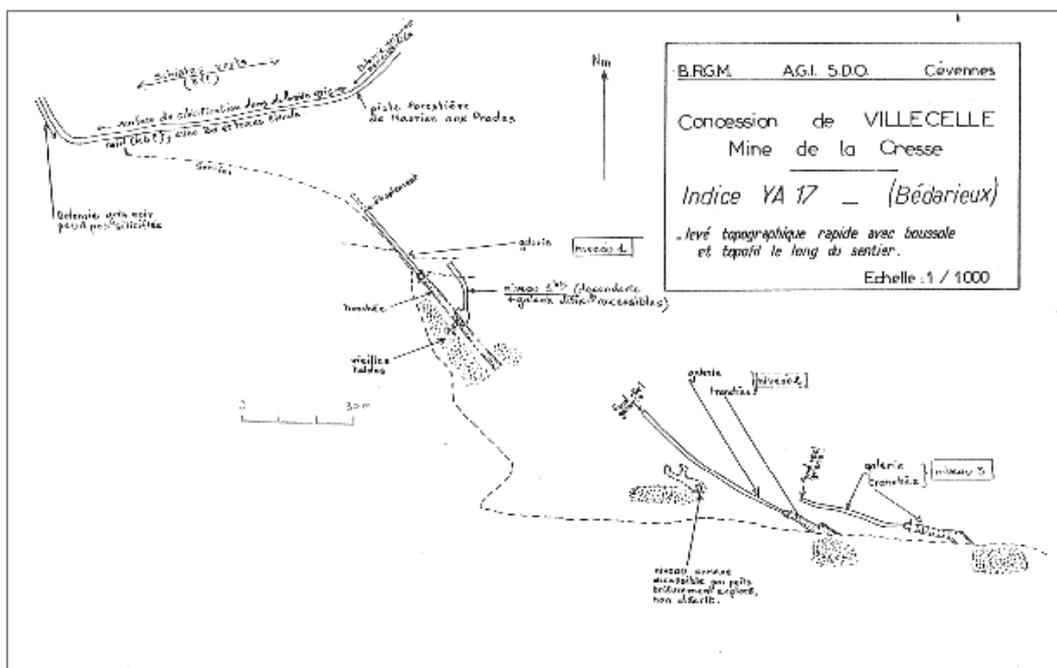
La Cresse, plan des travaux miniers (Ayme, 1984) – Ne tenir compte que de l'échelle graphique
